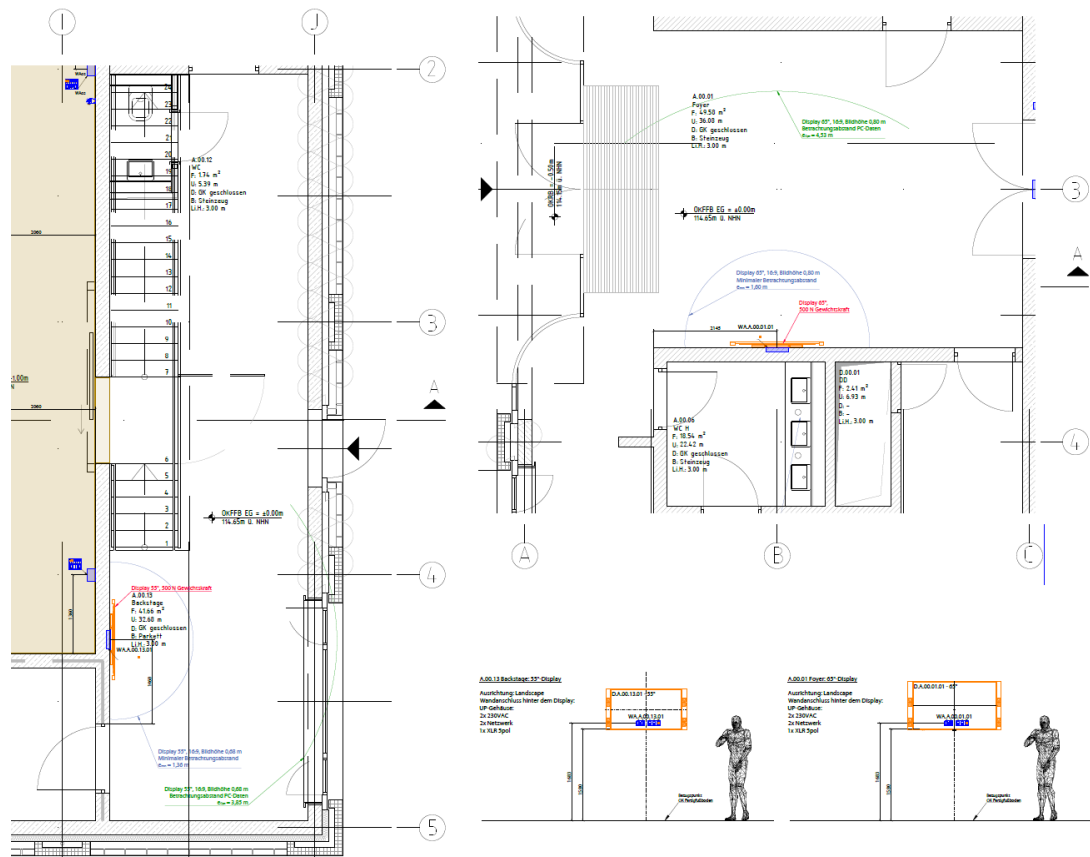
Grundriss EG, Foyer und Backstage
